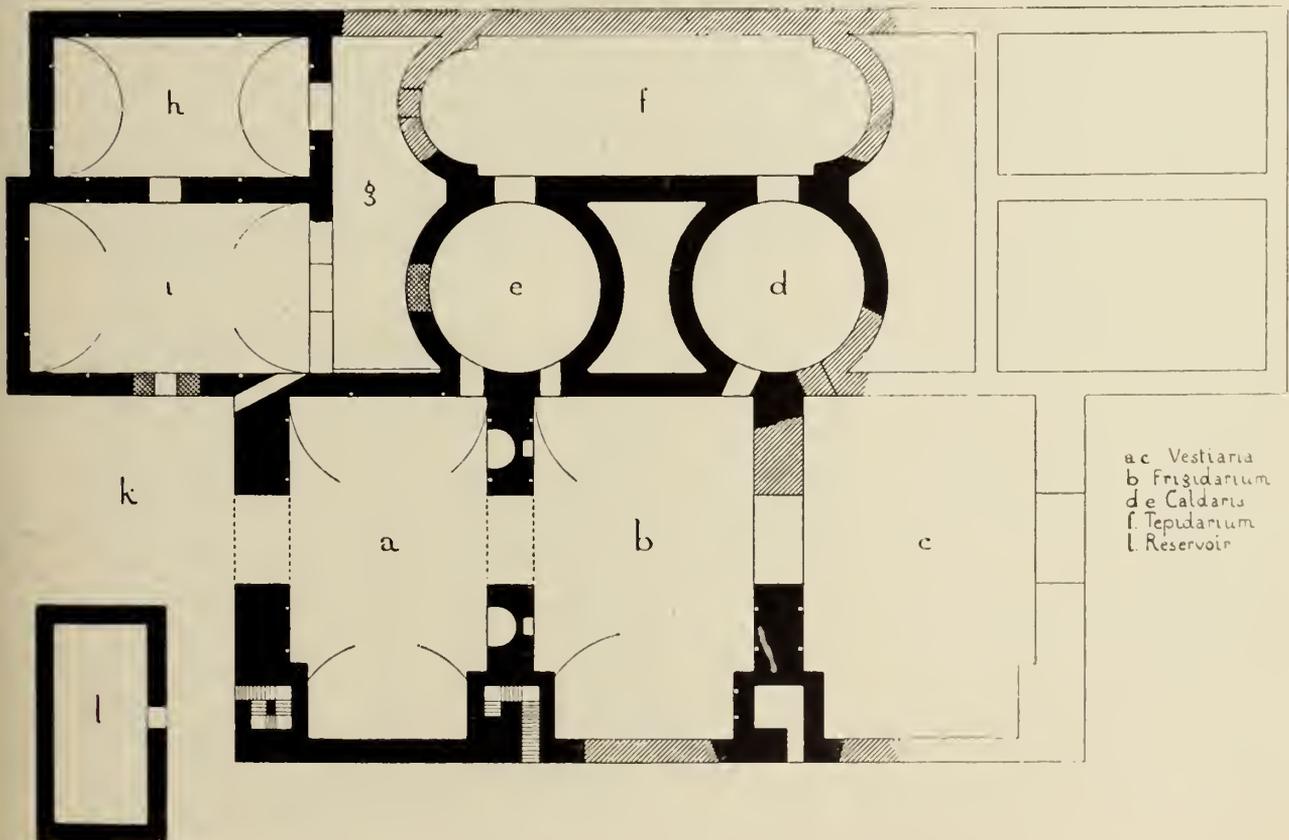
eš-Suhba: Thermen: Grundriß nach Butler 384, Fig. 134.
